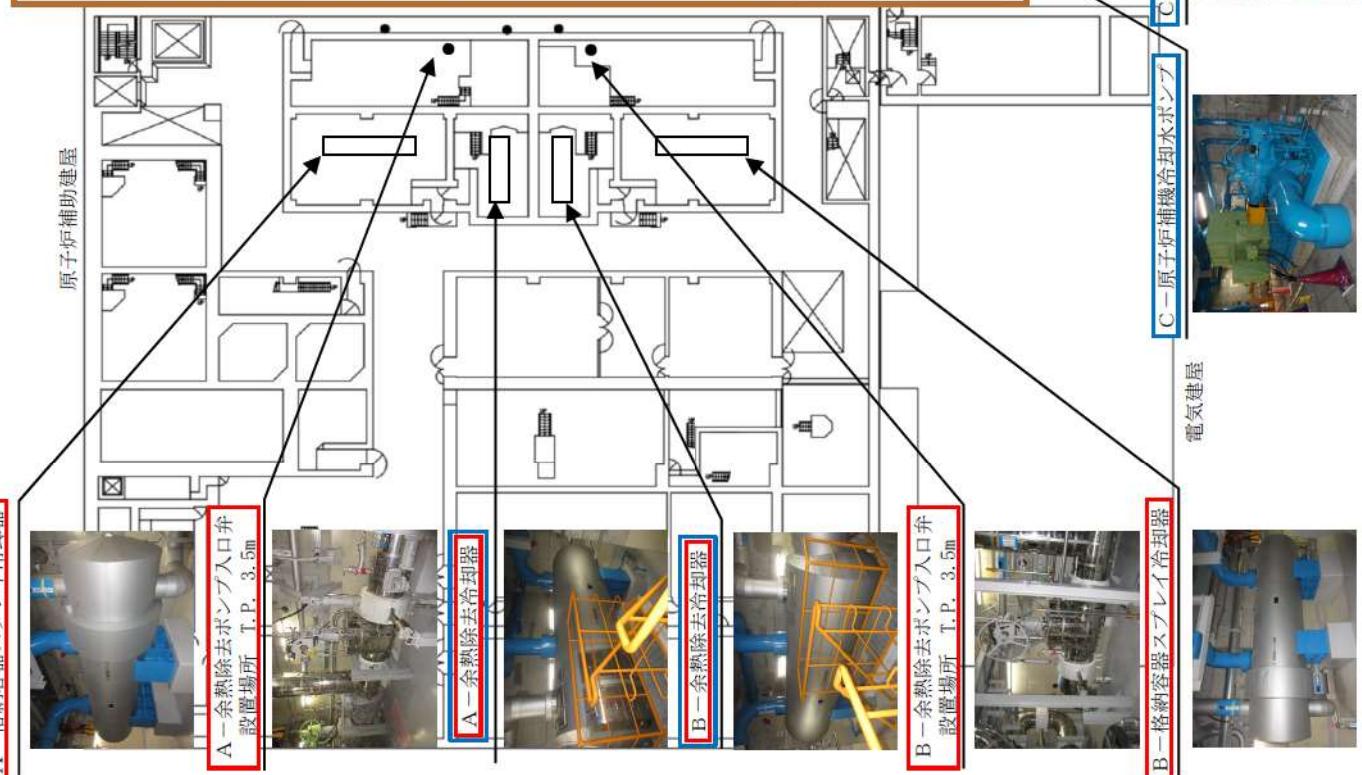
7-2-2 配置図 (T. P. 2, 3 m)
